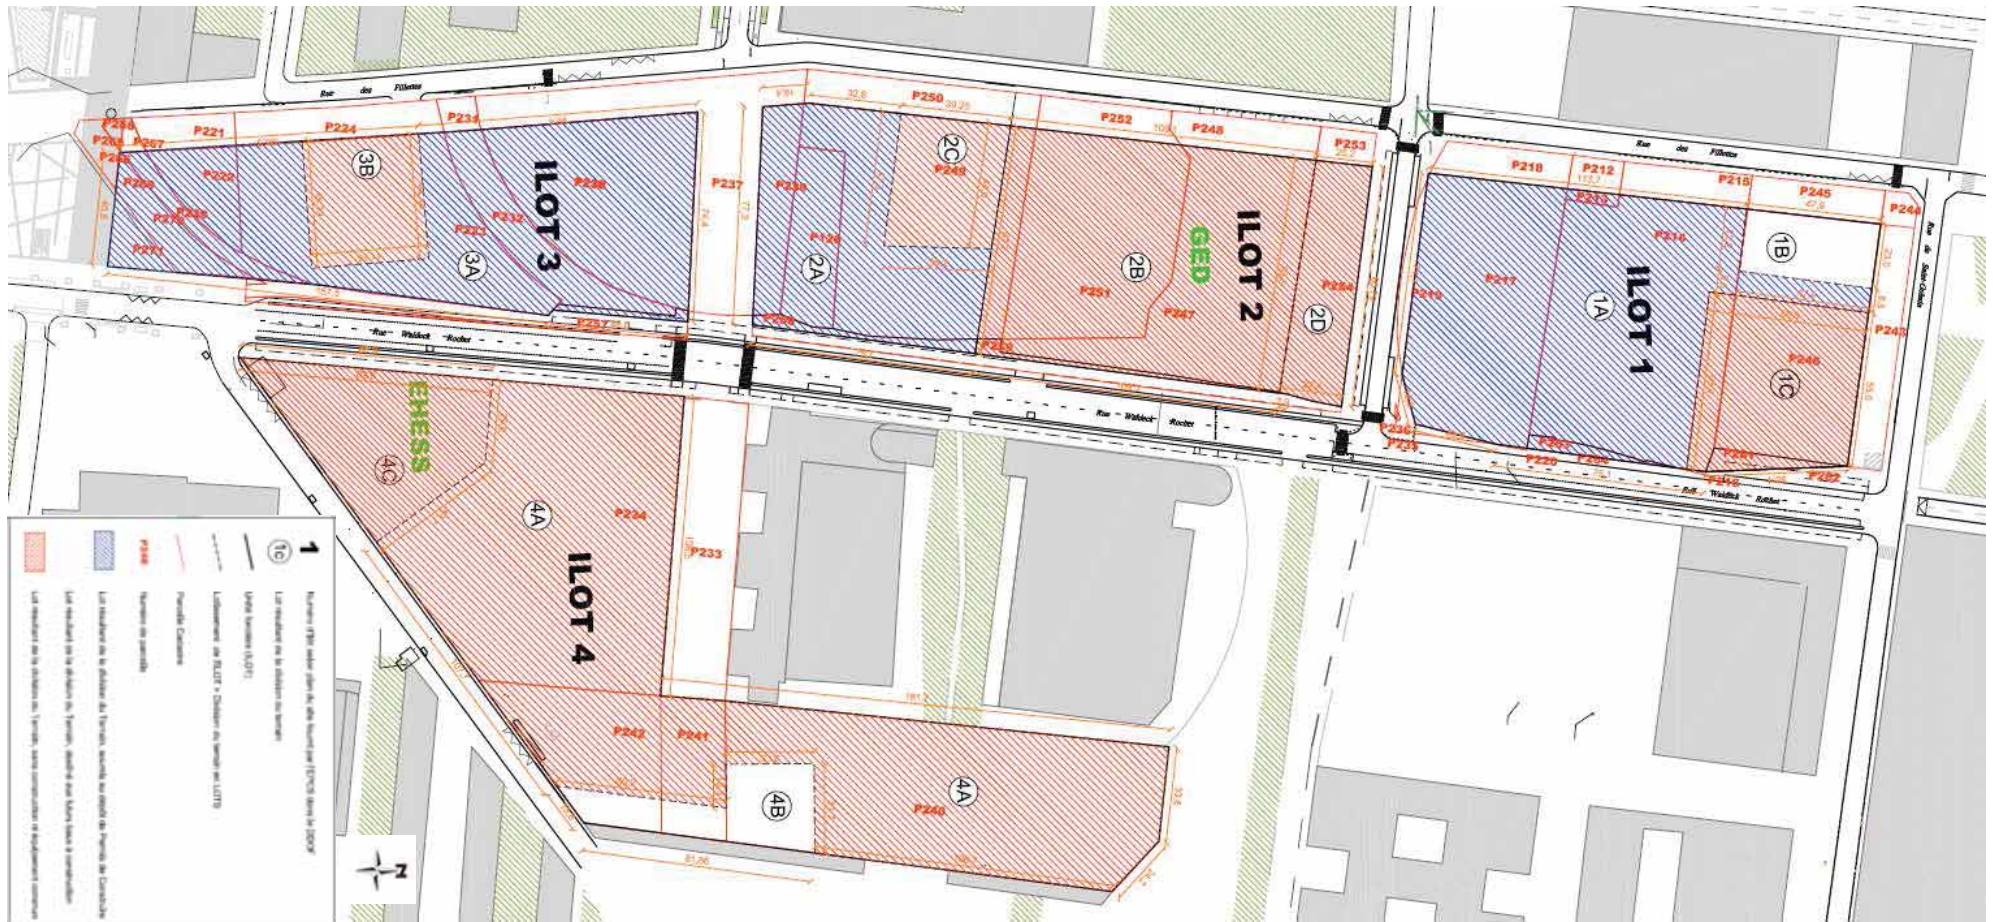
Extrait du plan cadastral du Campus Condorcet – Site d'Aubervilliers et découpage en îlots (Source : GROUPEMENT)
